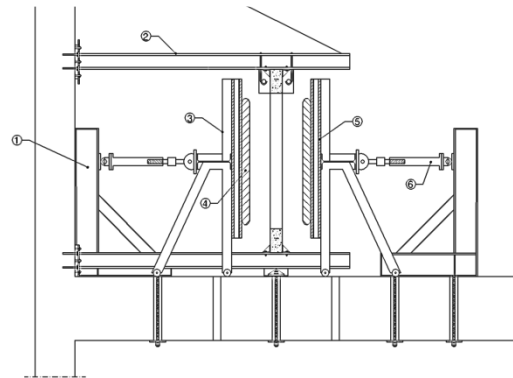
Sistema de ensaio fora do plano: 1 - Pórtico de reação para o atuador horizontal; 2 - Viga transversal para o pórtico de betão armado; 3 - Estrutura de aplicação de carga e de suporte para os airbags; 4 - Airbags; 5 - Painel de madeira; 6 - Atuador horizontal.
